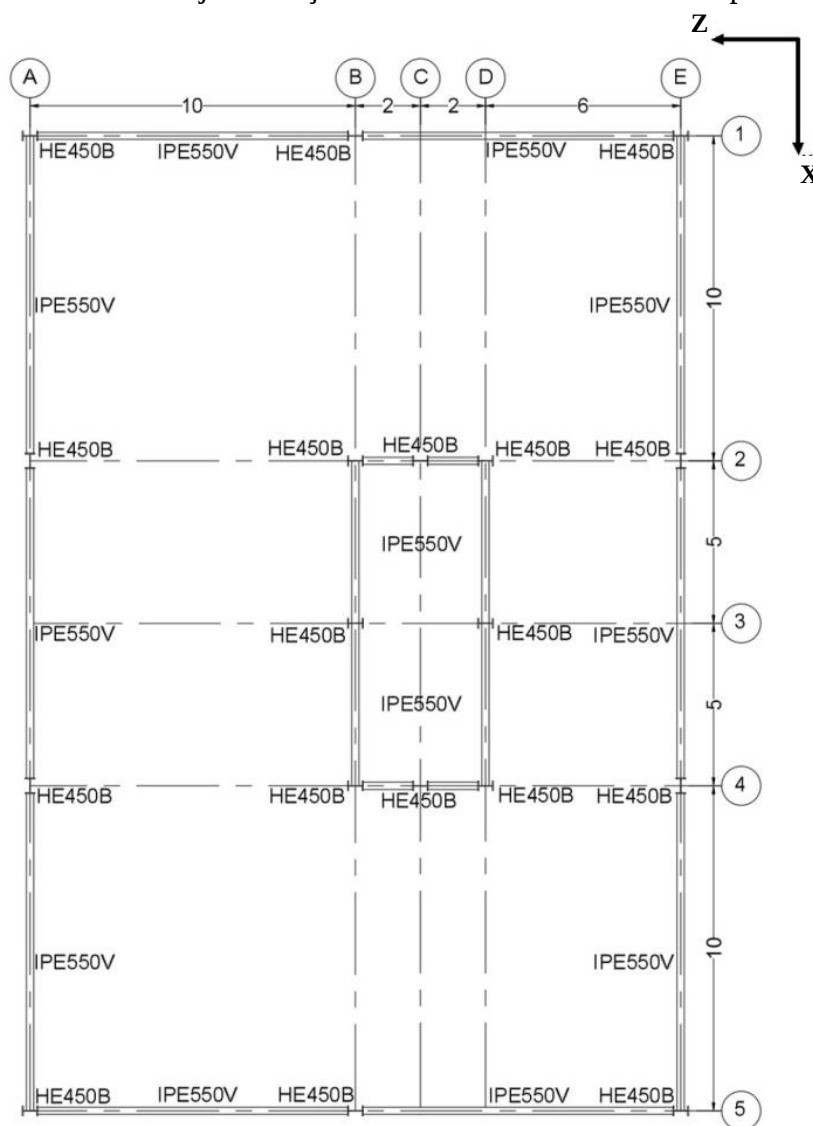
Planta 1º ao 10º pavimento (cotas em metros) (Assis, 2001)
